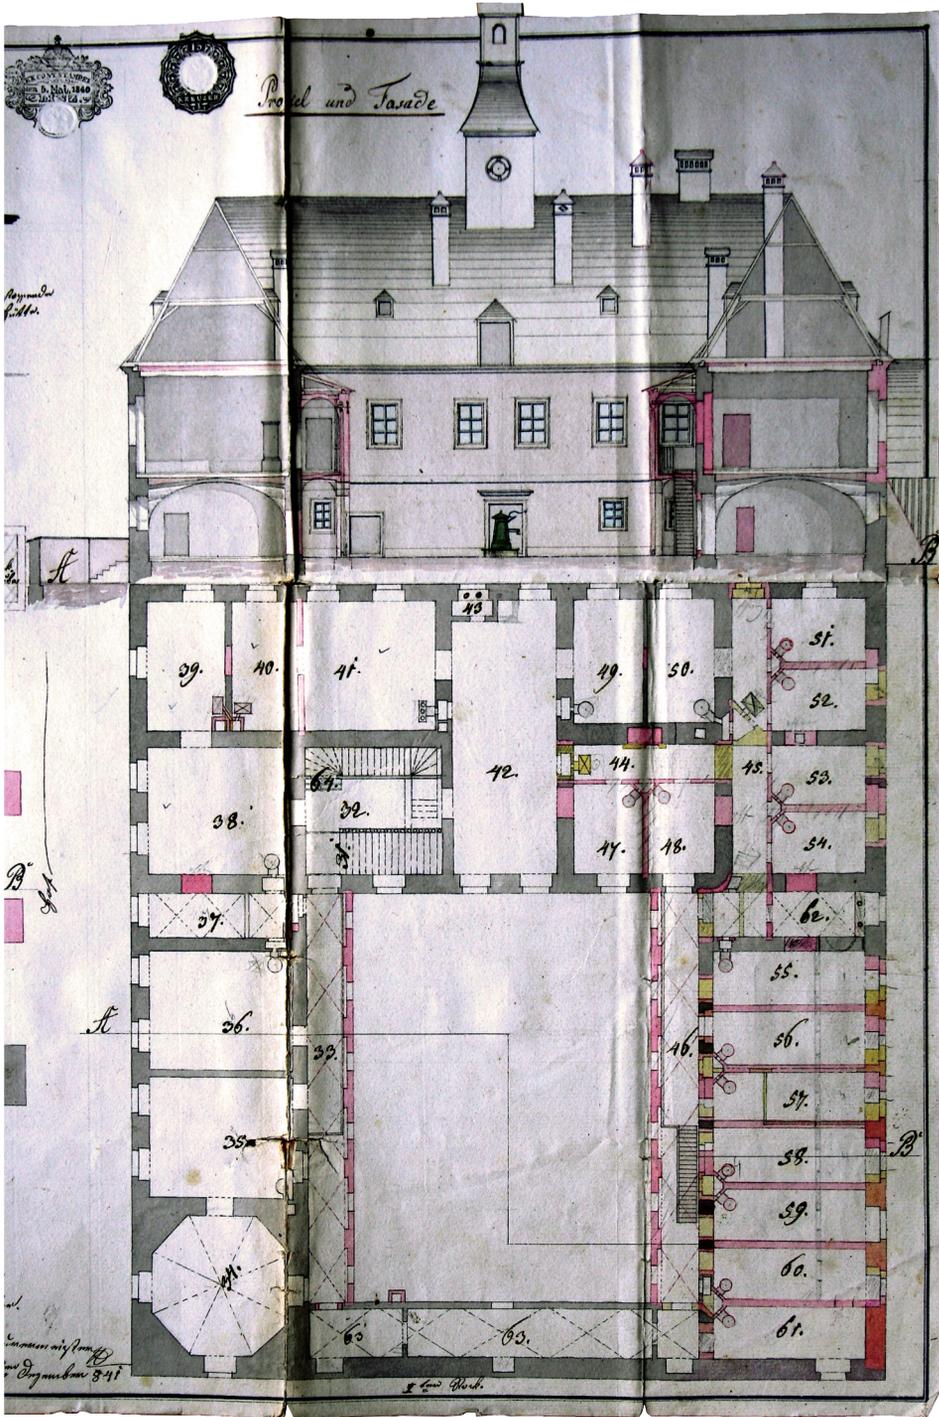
Bauplan von 1841: Aufriss der Hoffassade. Wie oben.
